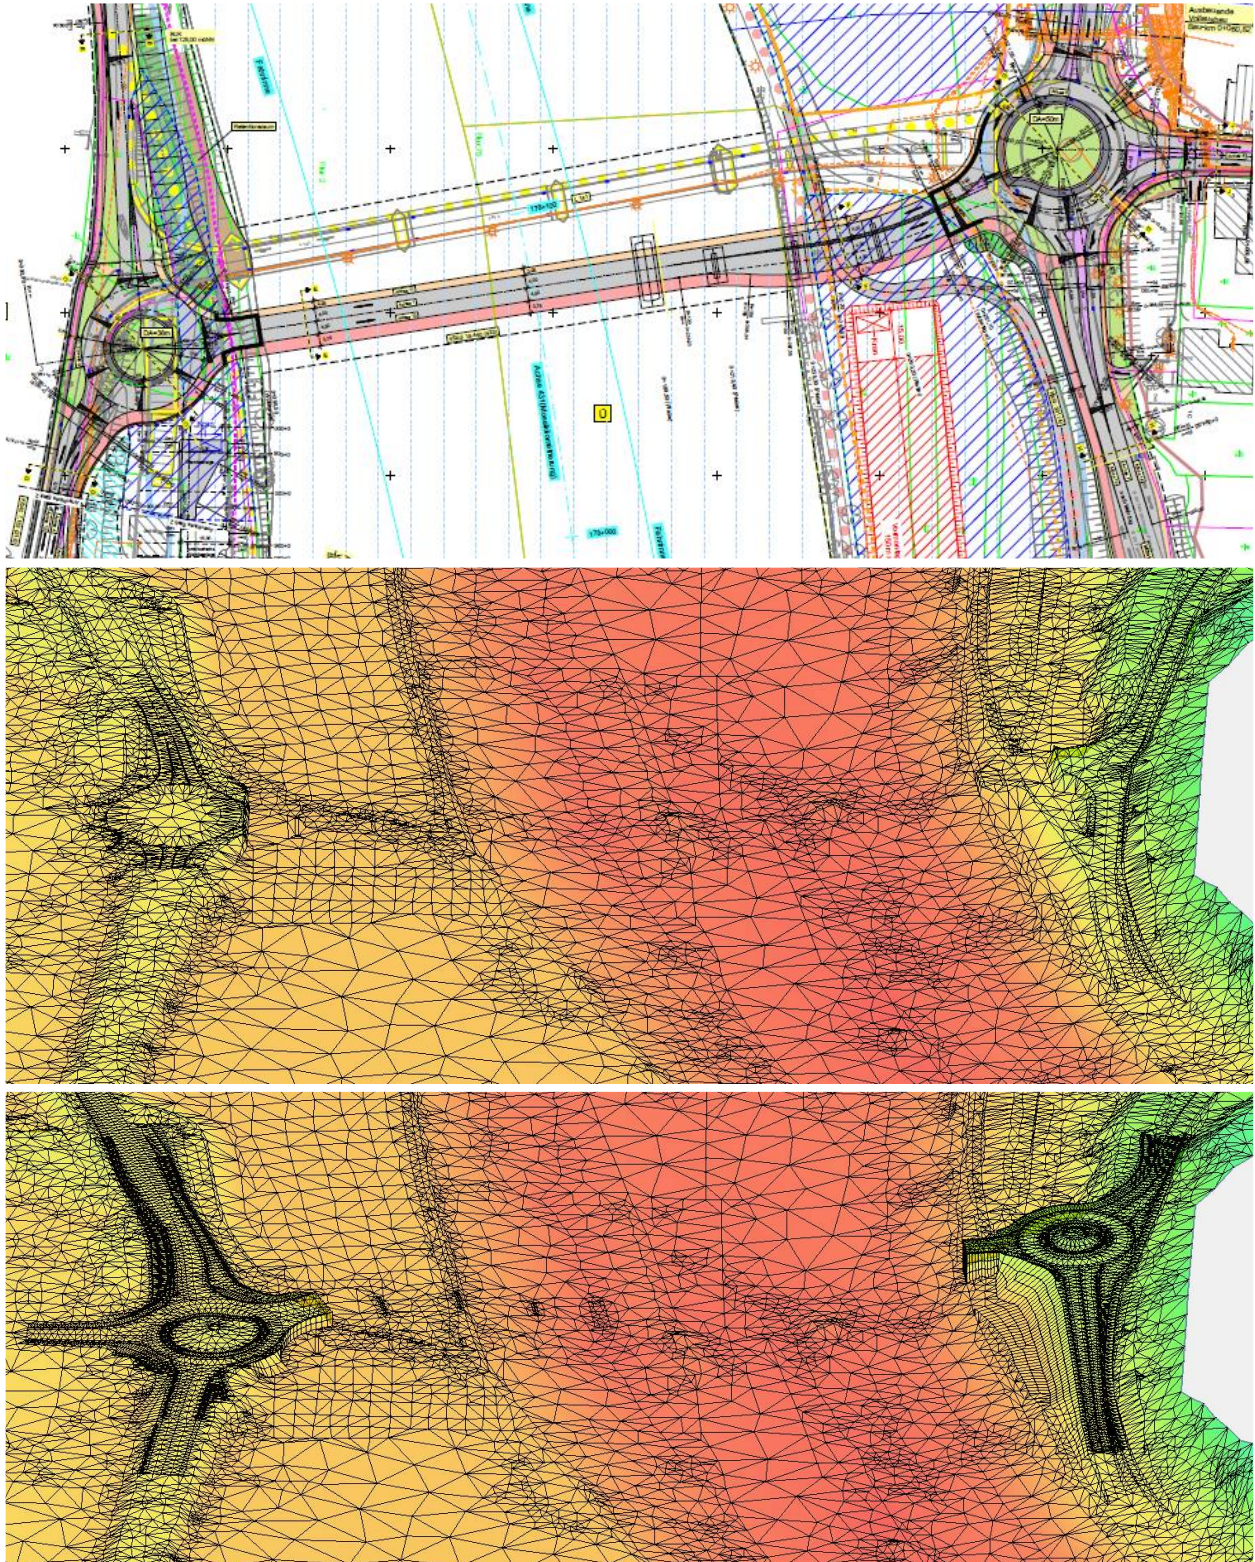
2D-Modell Planungszustand (oben: Lageplan Ausschnitt Stand 08.01.20, Mitte: 2D-Modell Referenz-Zustand (Ausschnitt), unten: 2D-Modell Planung (Ausschnitt))
